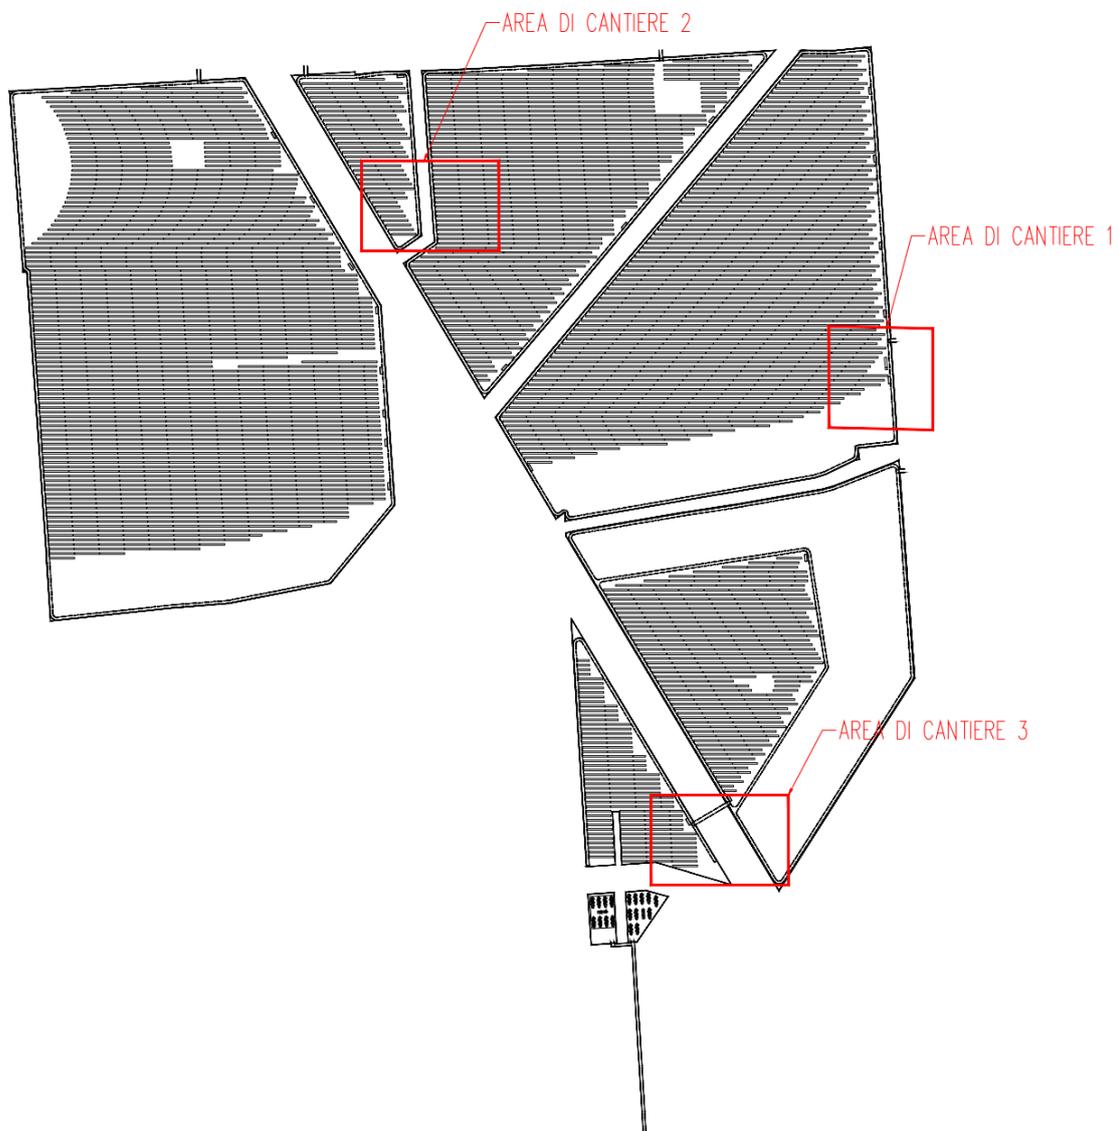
Planimetria delle aree di cantiere (elaborato G19501A01-E-20)
